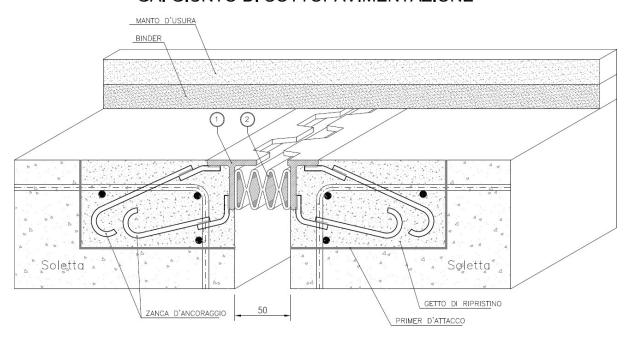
Dettaglio giunto impalcato rampe di svincolo con impalcato esistente come da Progetto Esecutivo
